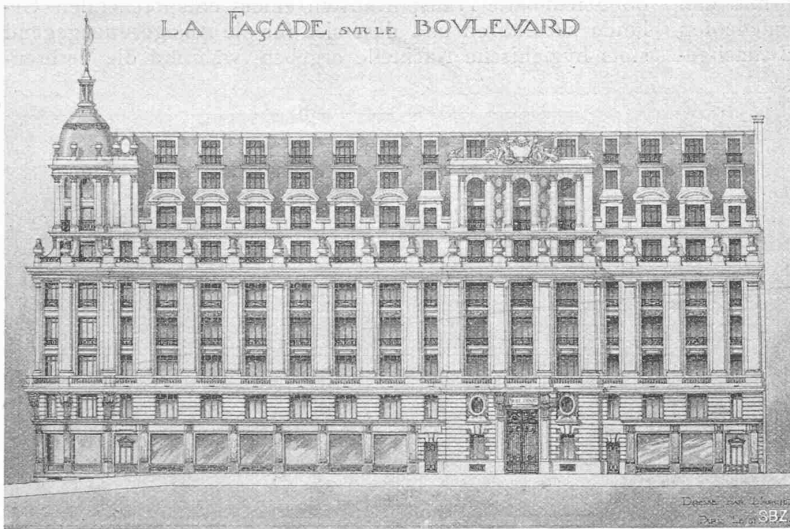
Entwurf Arch. Lefranc, Paris. — Hauptfassade am Boulevard Poissonnière. — 1:600.
